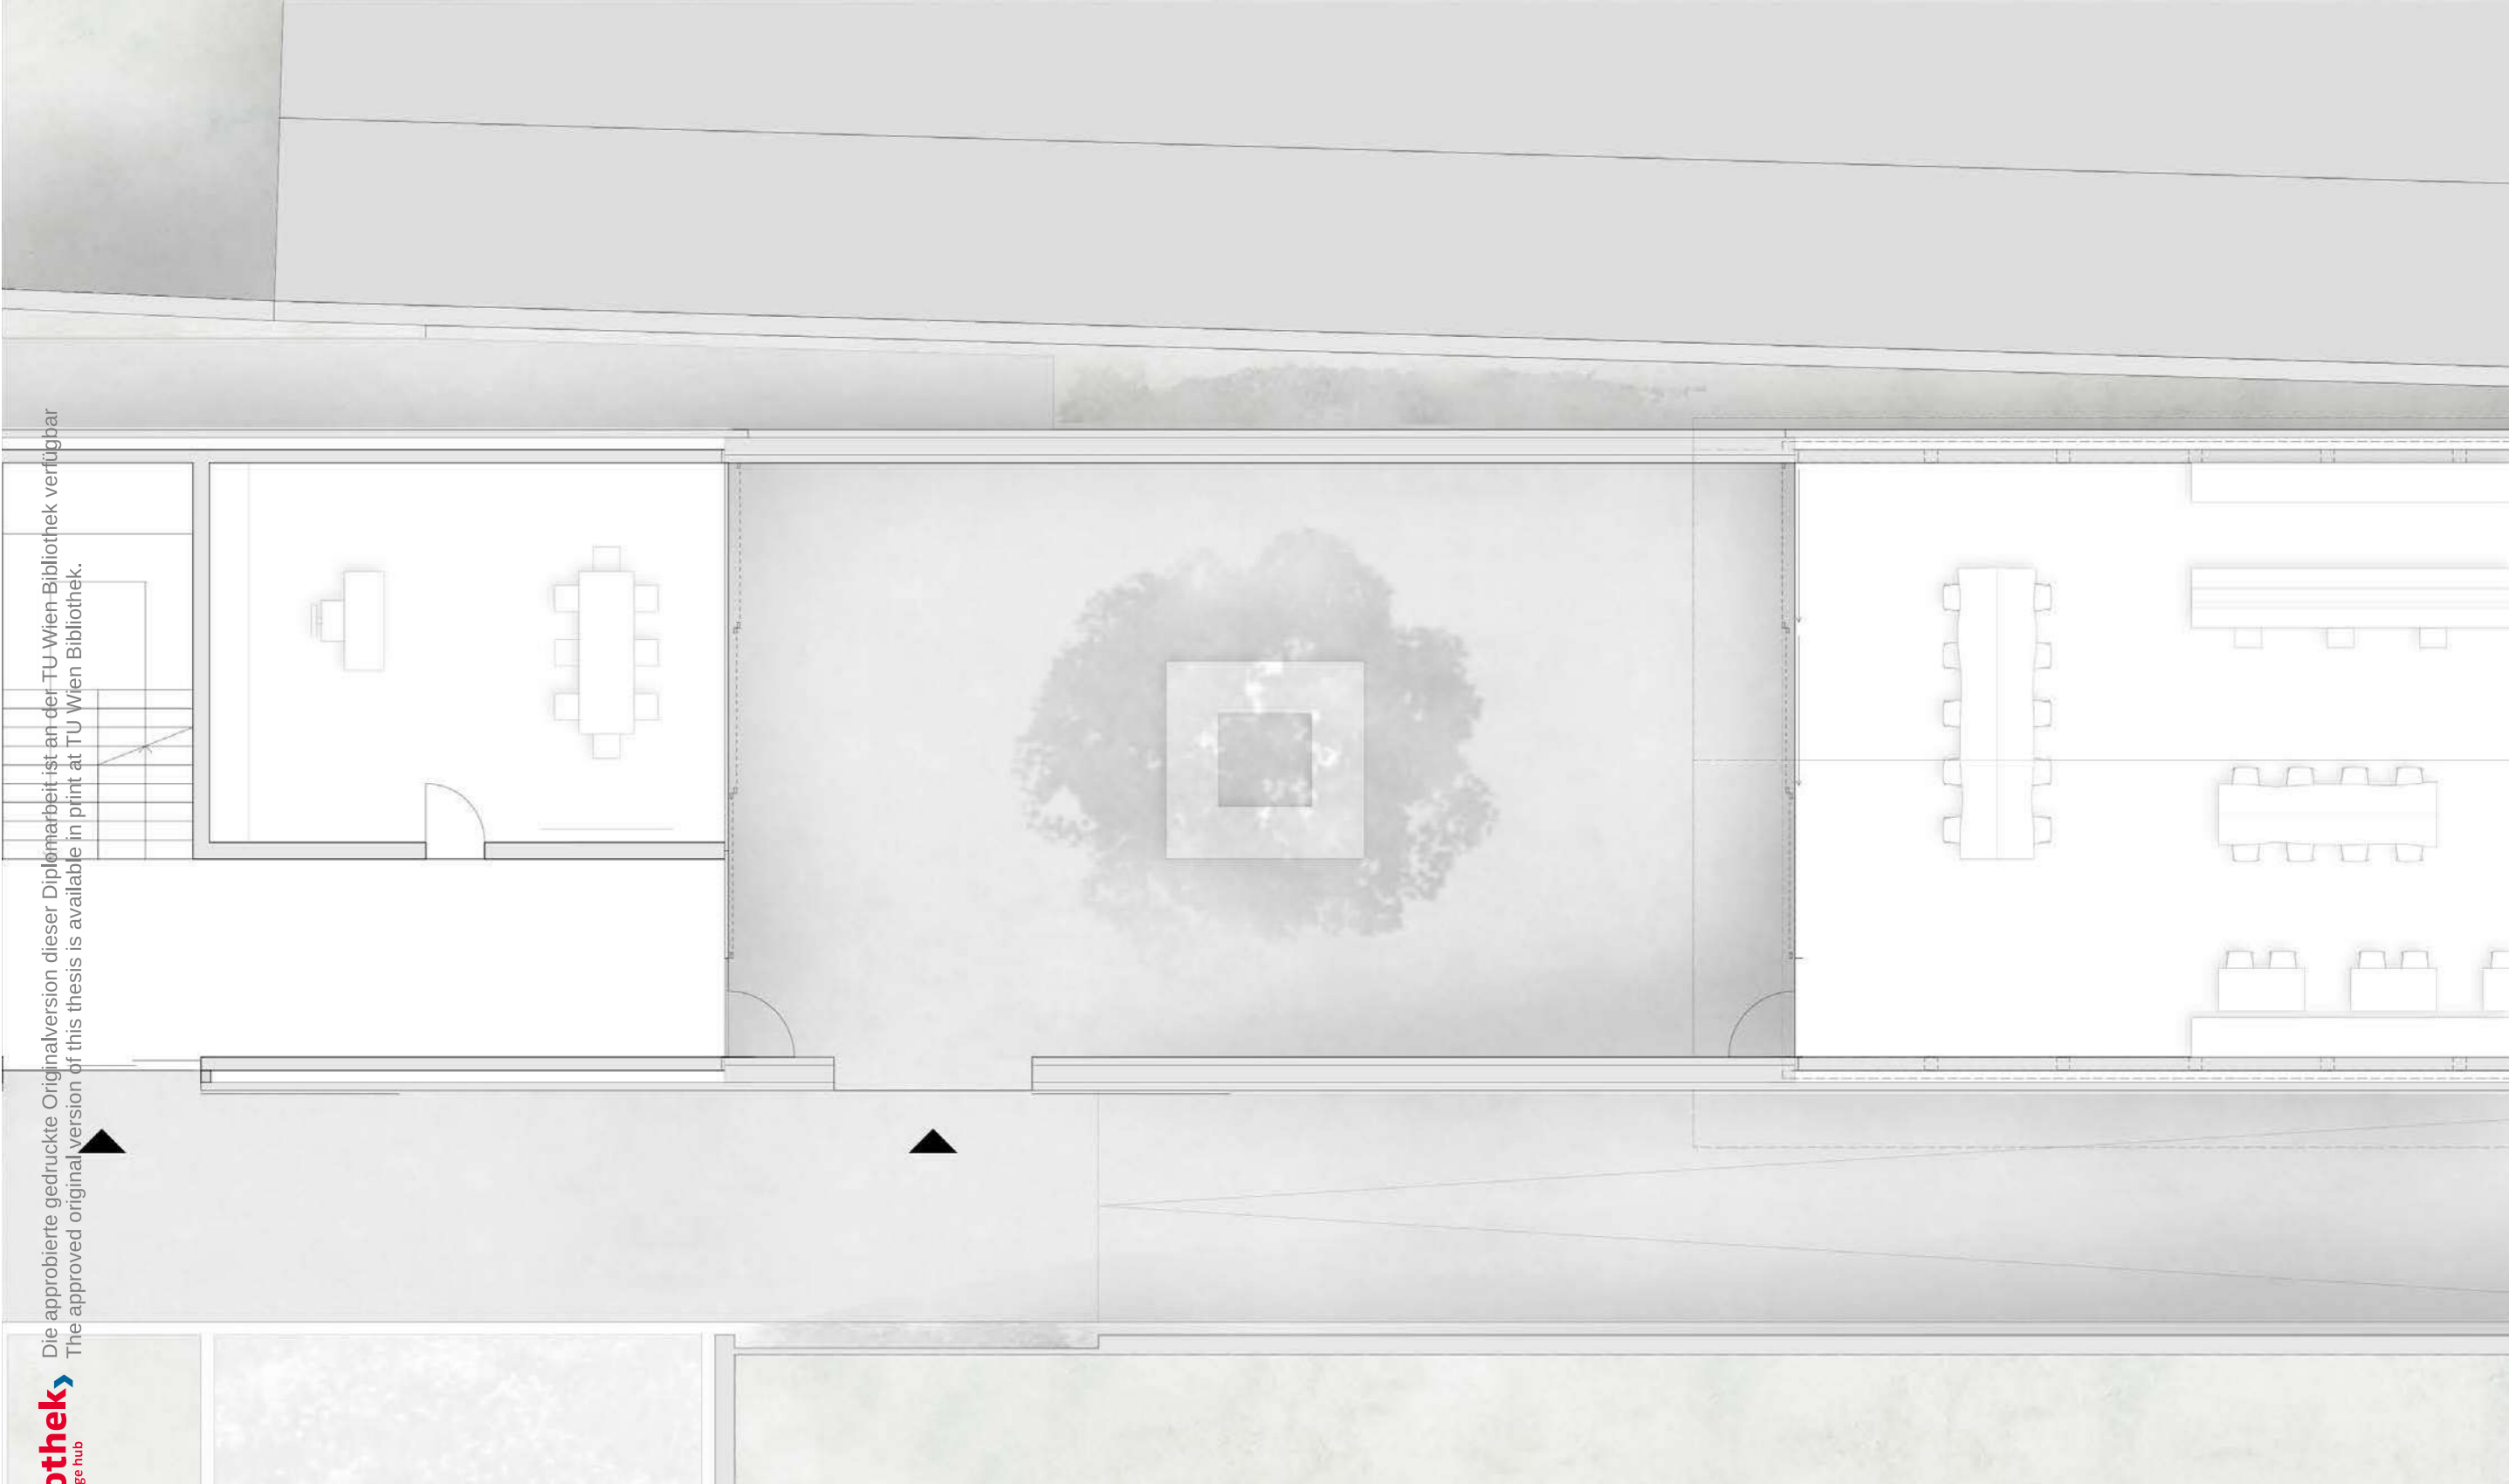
Grundriss Hof 2 M 1:100
